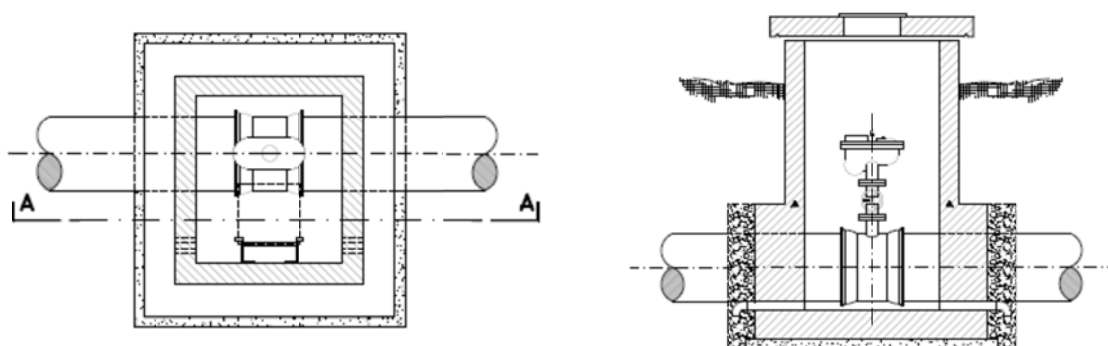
Pianta e sezione pozzetto di sfiato tipologico
